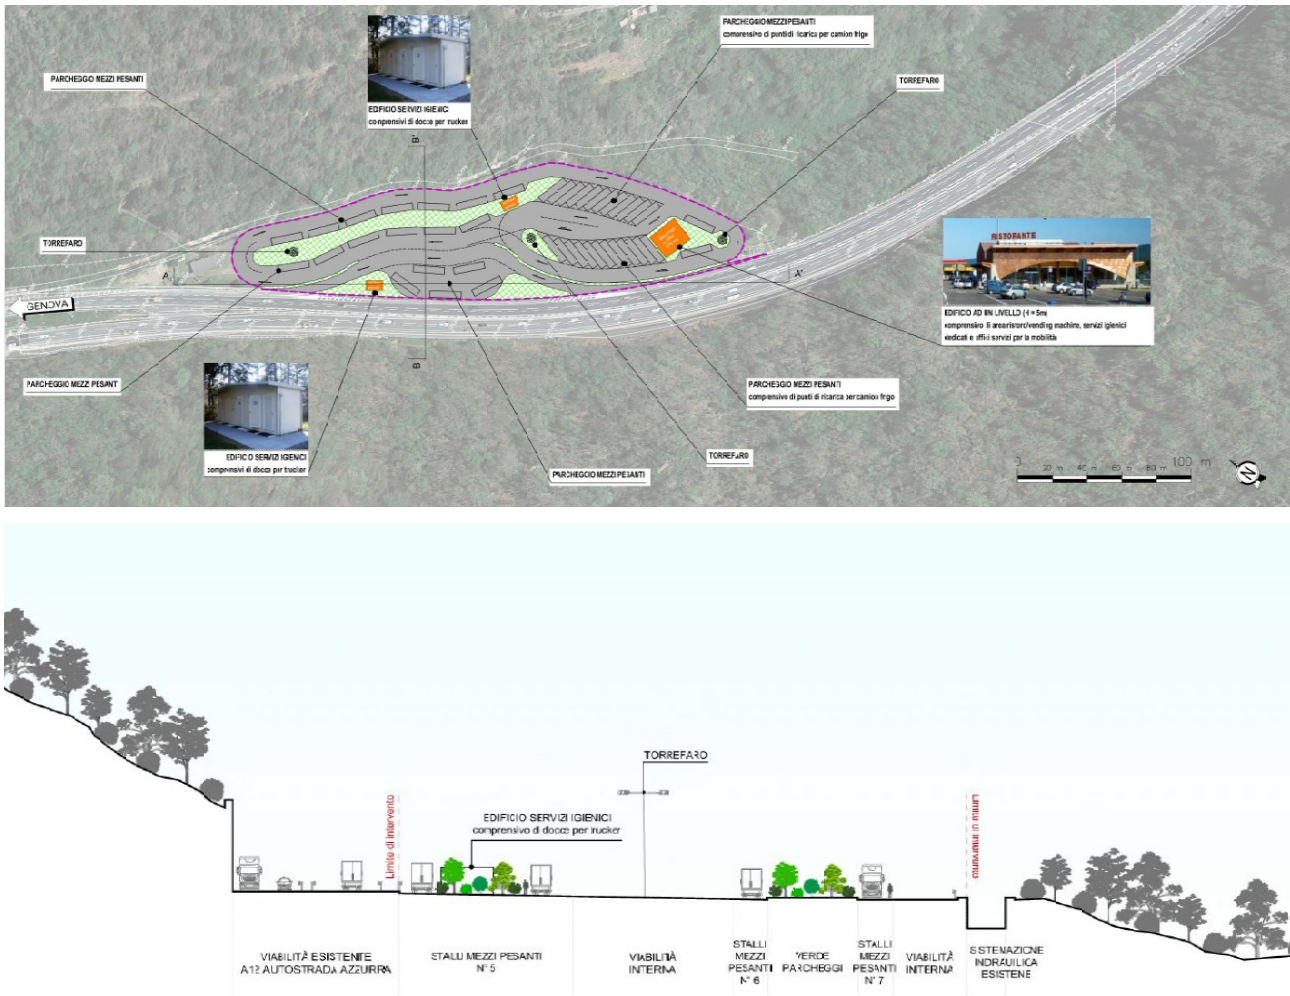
Planimetria (in alto) e sezione (in basso) del progetto. Fonte "Planimetria e sezione di progetto" allegato alla Lista di controllo.
